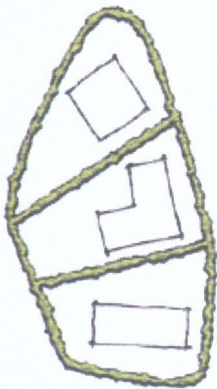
Amøbeformede grunde, hvor de yderste grunde har afrundede hjørner (§ 4.1).
